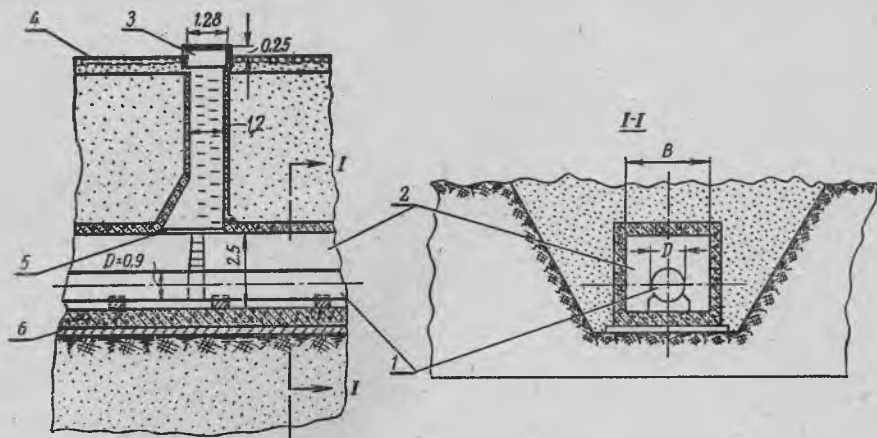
Штольня для укладки всасывающей трубы с монтажным колодезем:
